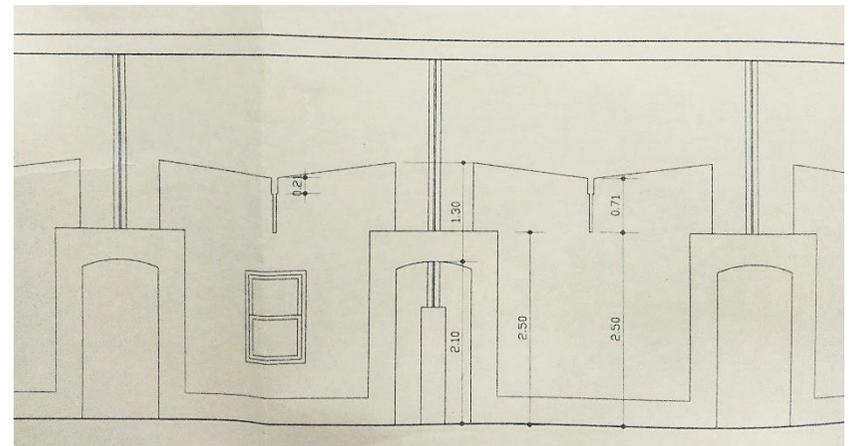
Alzado interior del proyecto debajo del nuevo forjado de la cubierta plana proyectado en 1996. Fuente: GMU.
